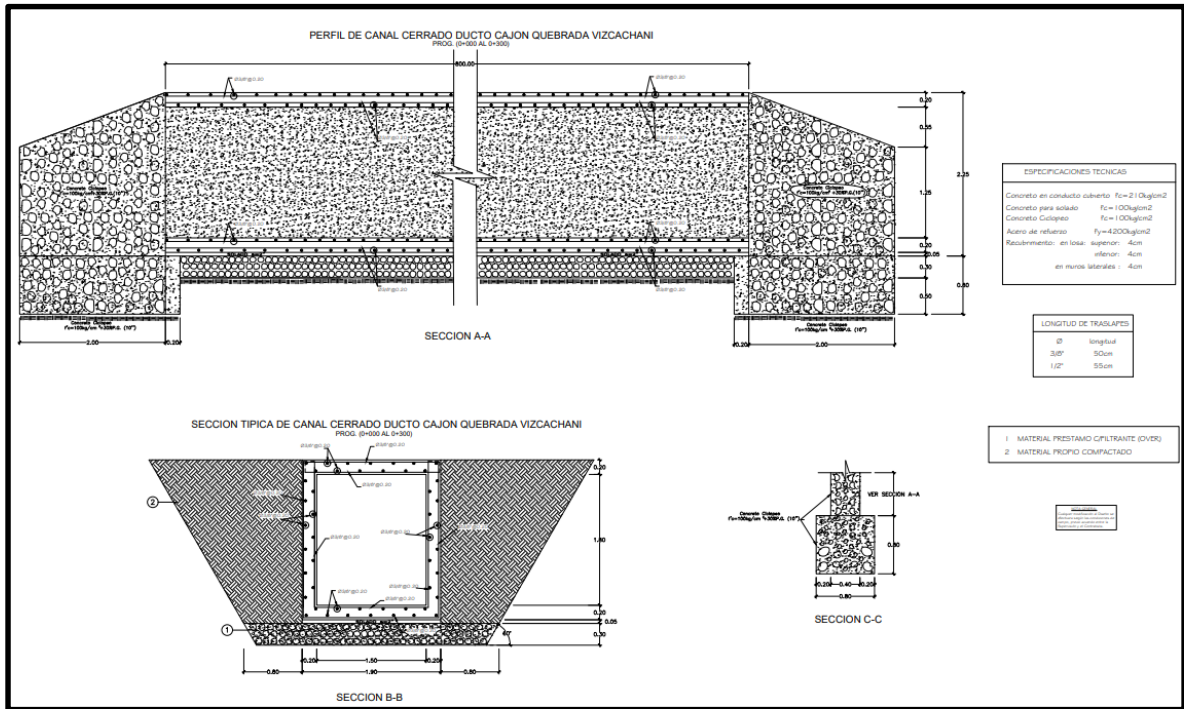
Vista frontal sección típica Sector Vizcachani
